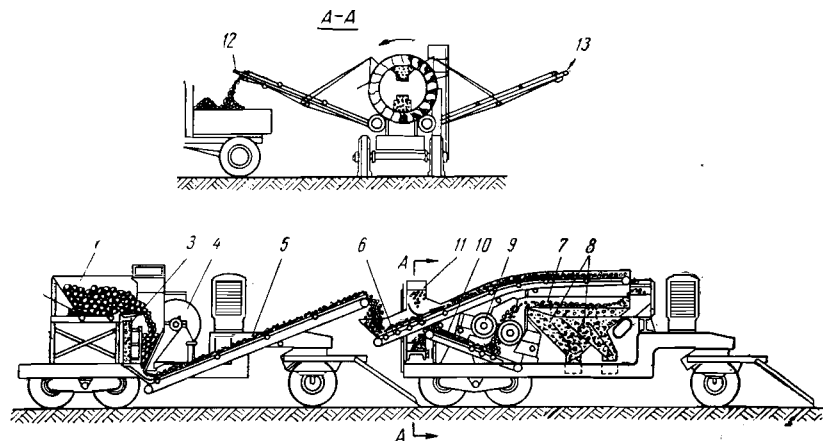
Передвижная дробильно-сортировочная установка СМ-9:
